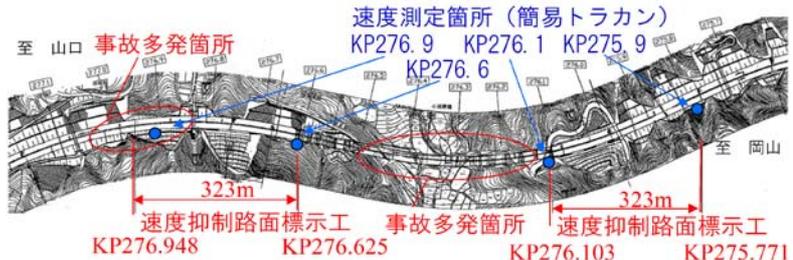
速度抑制路面標示工 対策平面図(小河原橋付近)
